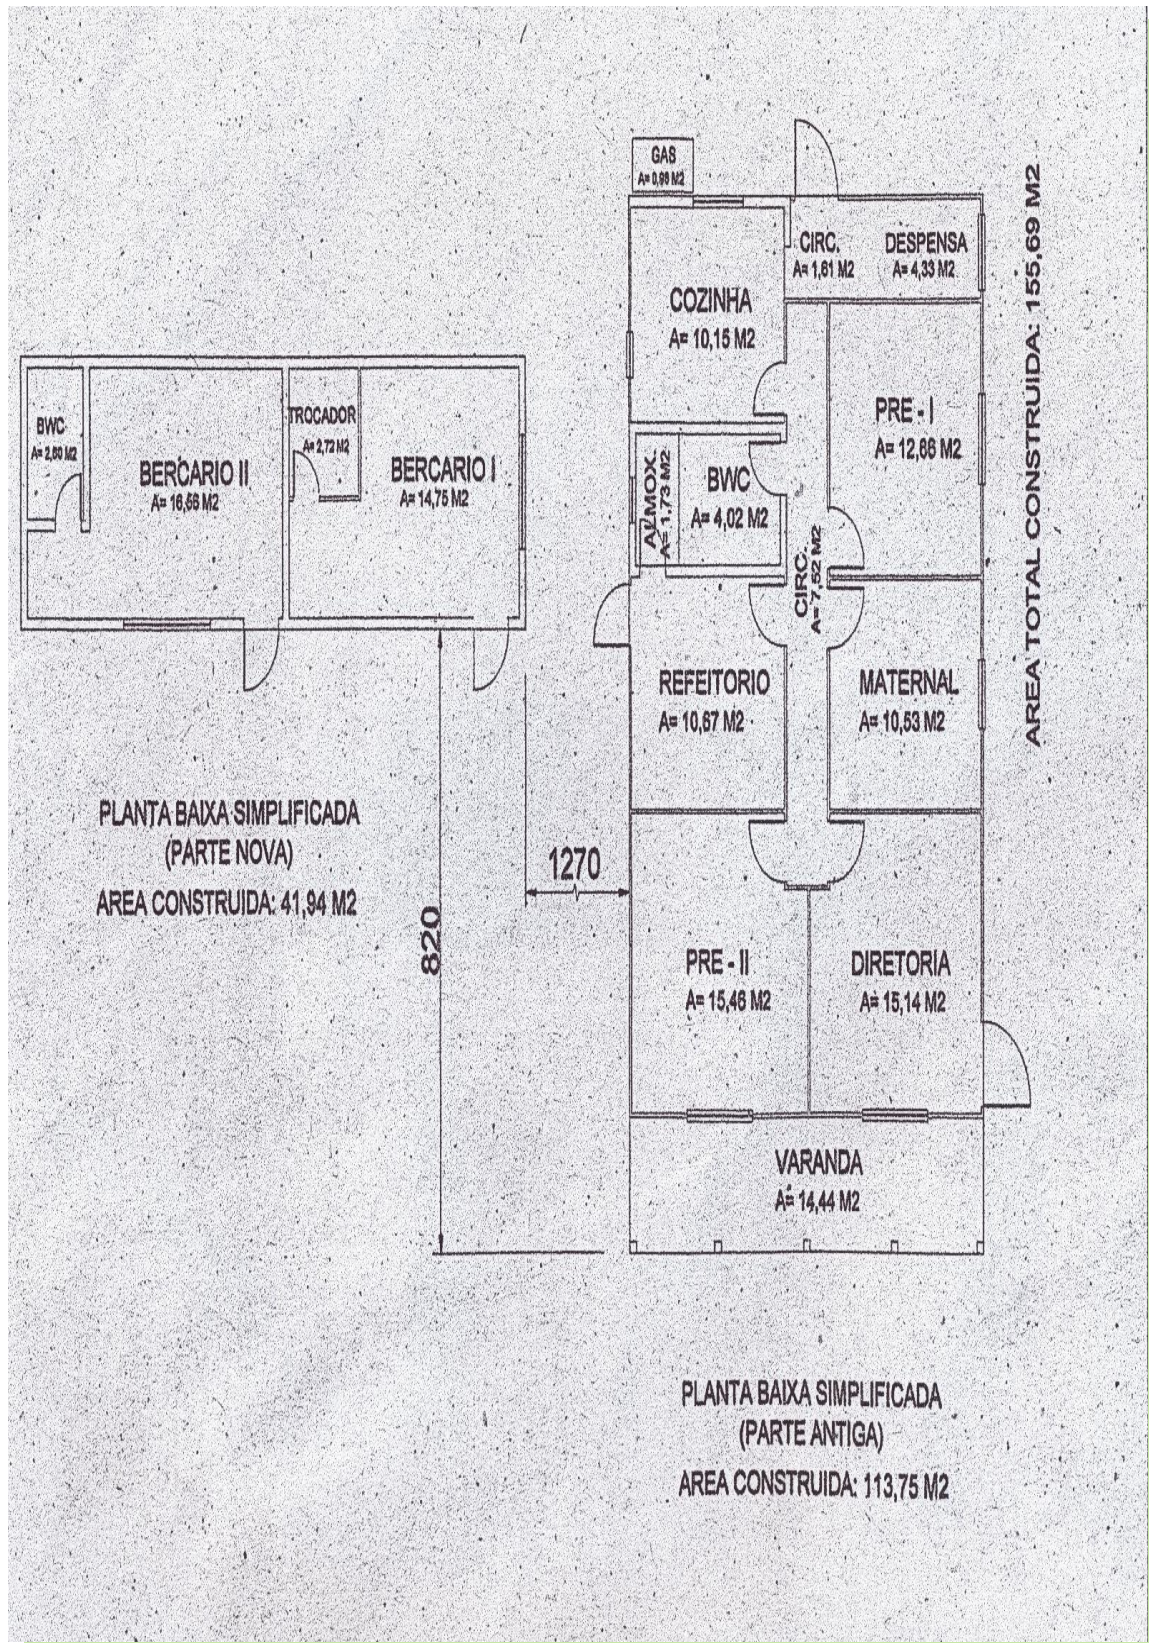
PLANTA BAIXA SIMPLIFICADA DO CMEI.
